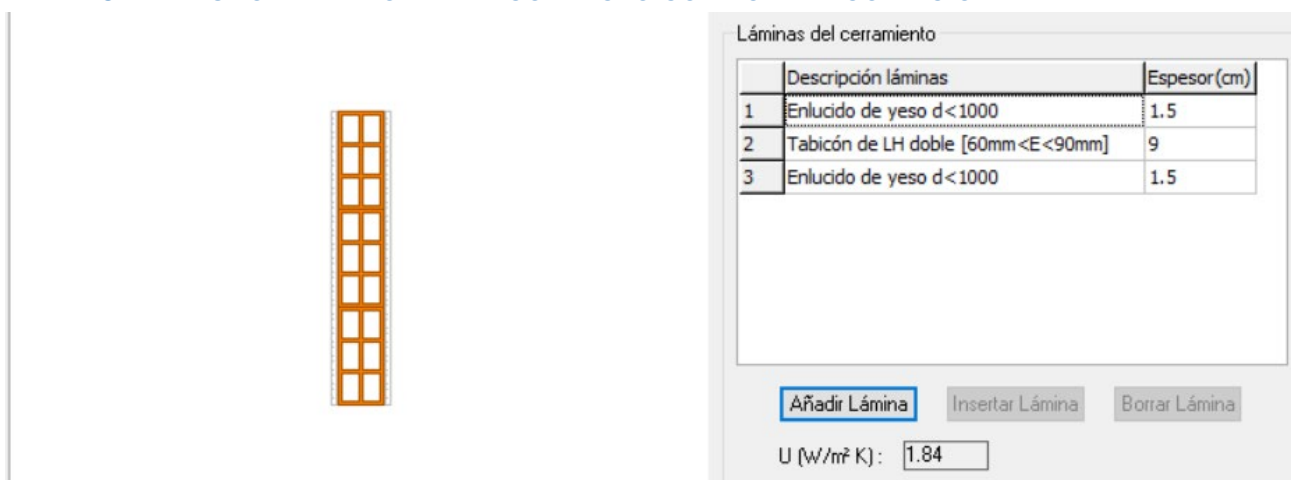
SECCIÓN Y MATERIALES MURO INTERIOR
